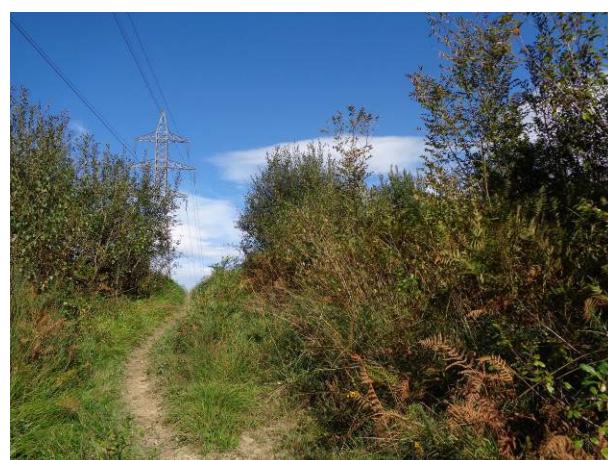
Vista general del camino de acceso proyectado para llegar a la implantación del AP. 7ZALN.
